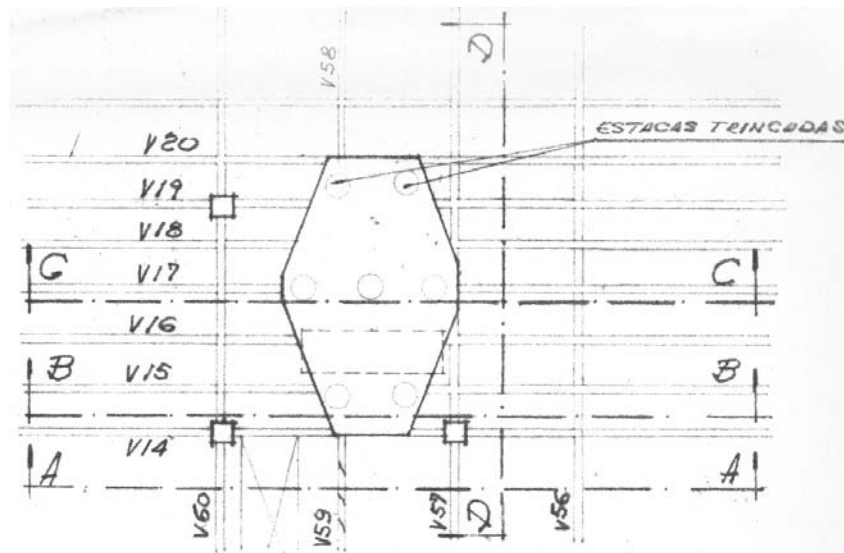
6 – Vista superior do apoio central (Fonte: Pasta da Obra n° 1438, CRO-11, Brasília – 1974)
